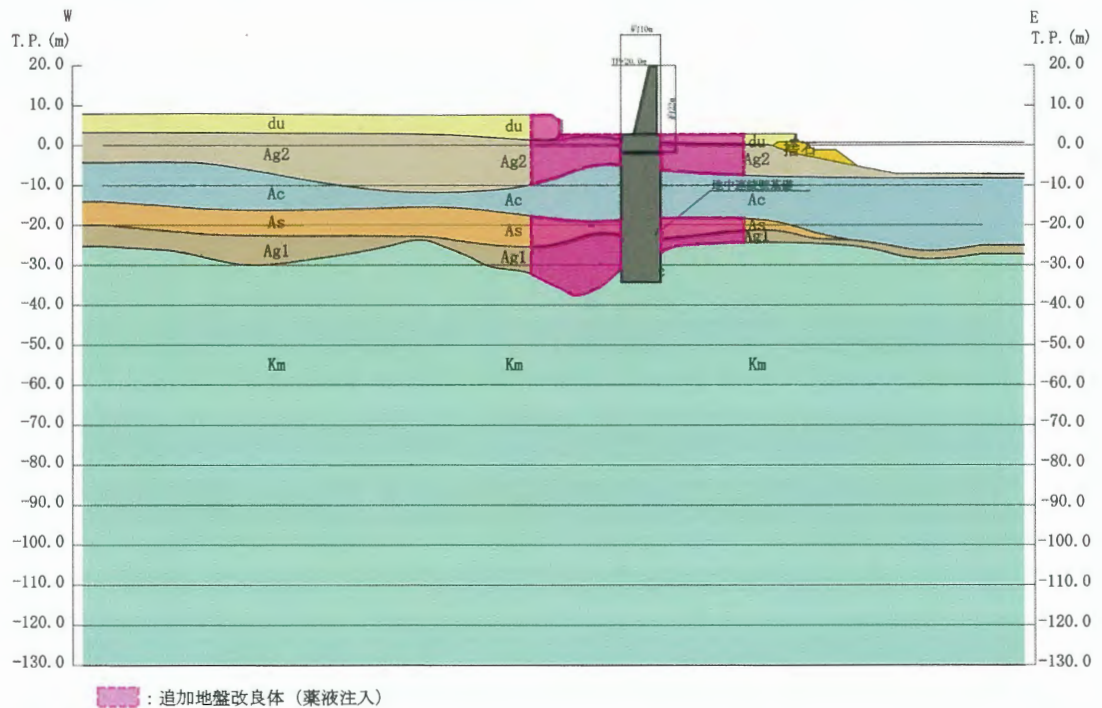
(4) 防潮堤 (鉄筋コンクリート防潮壁) 及び地盤改良体の断面位置 (④-④断面)
